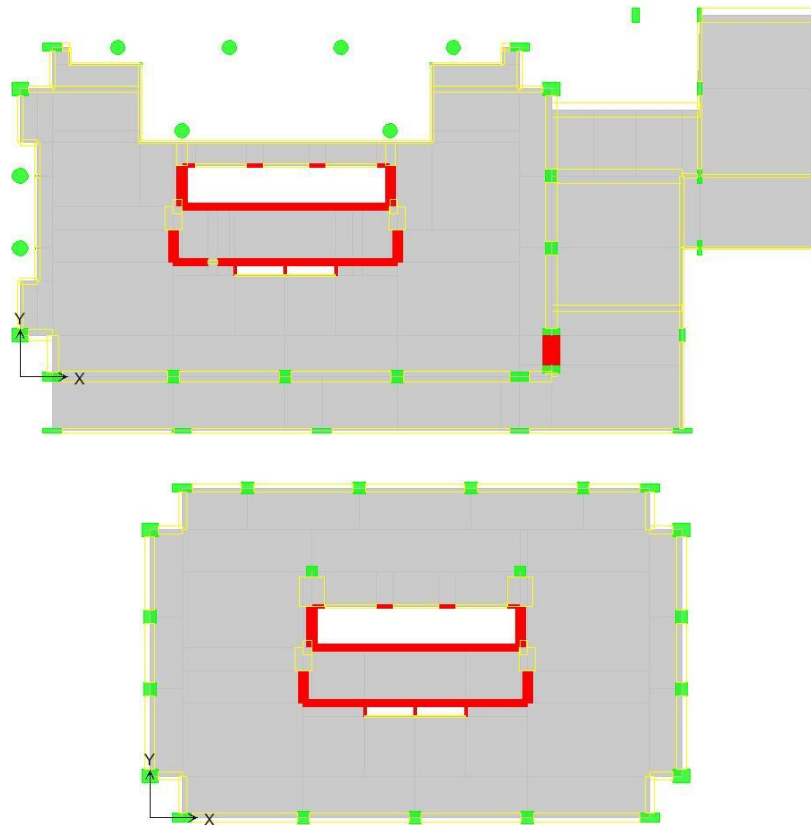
Planta primer piso (arriba) y piso tipo (abajo) edificio O1
